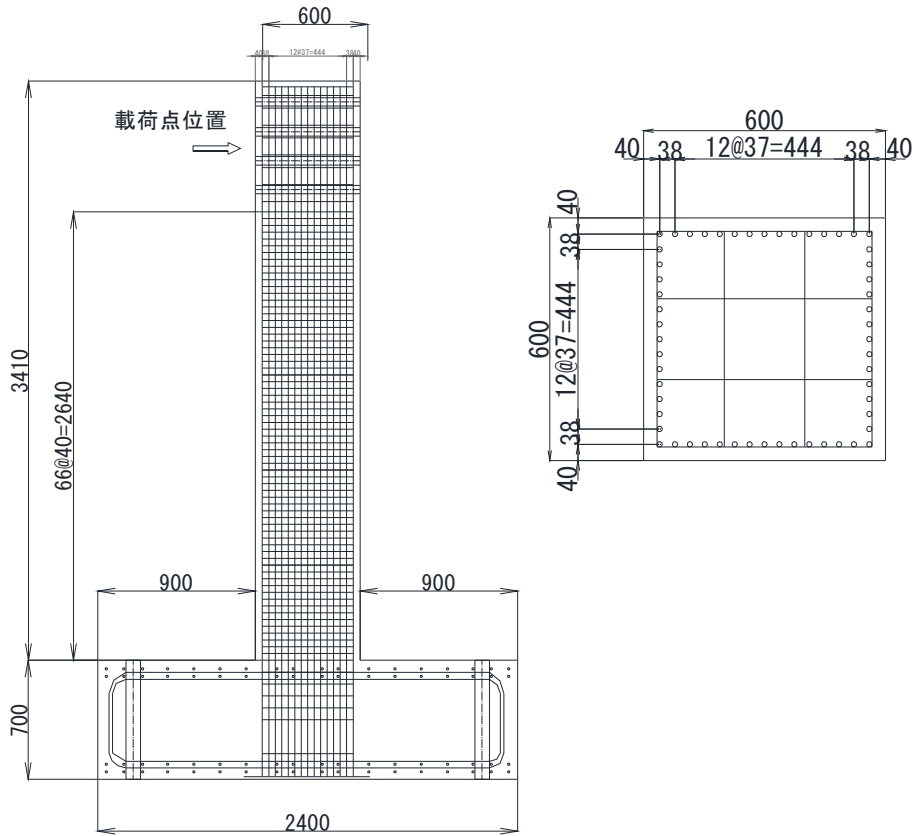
実験供試体構造諸元及び断面図(単位：mm)
